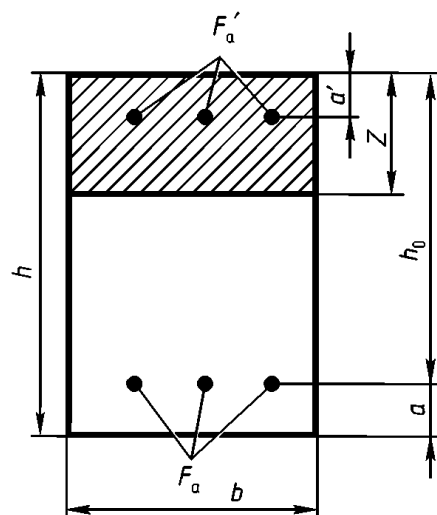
Поперечное сечение прямоугольного железобетонного элемента
